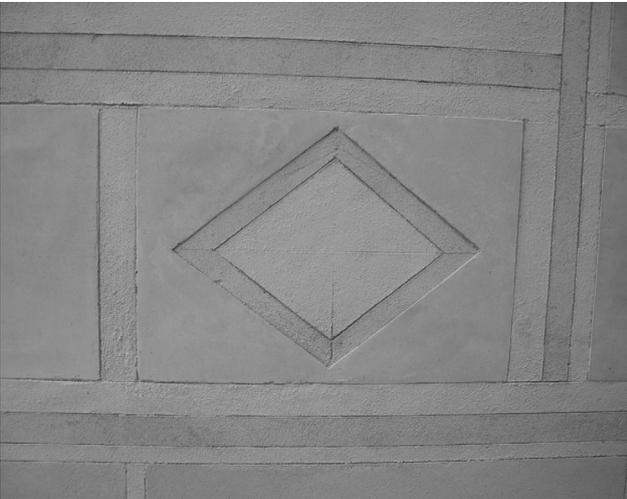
Detalle de la reconstrucción de la decoración en la fachada norte
